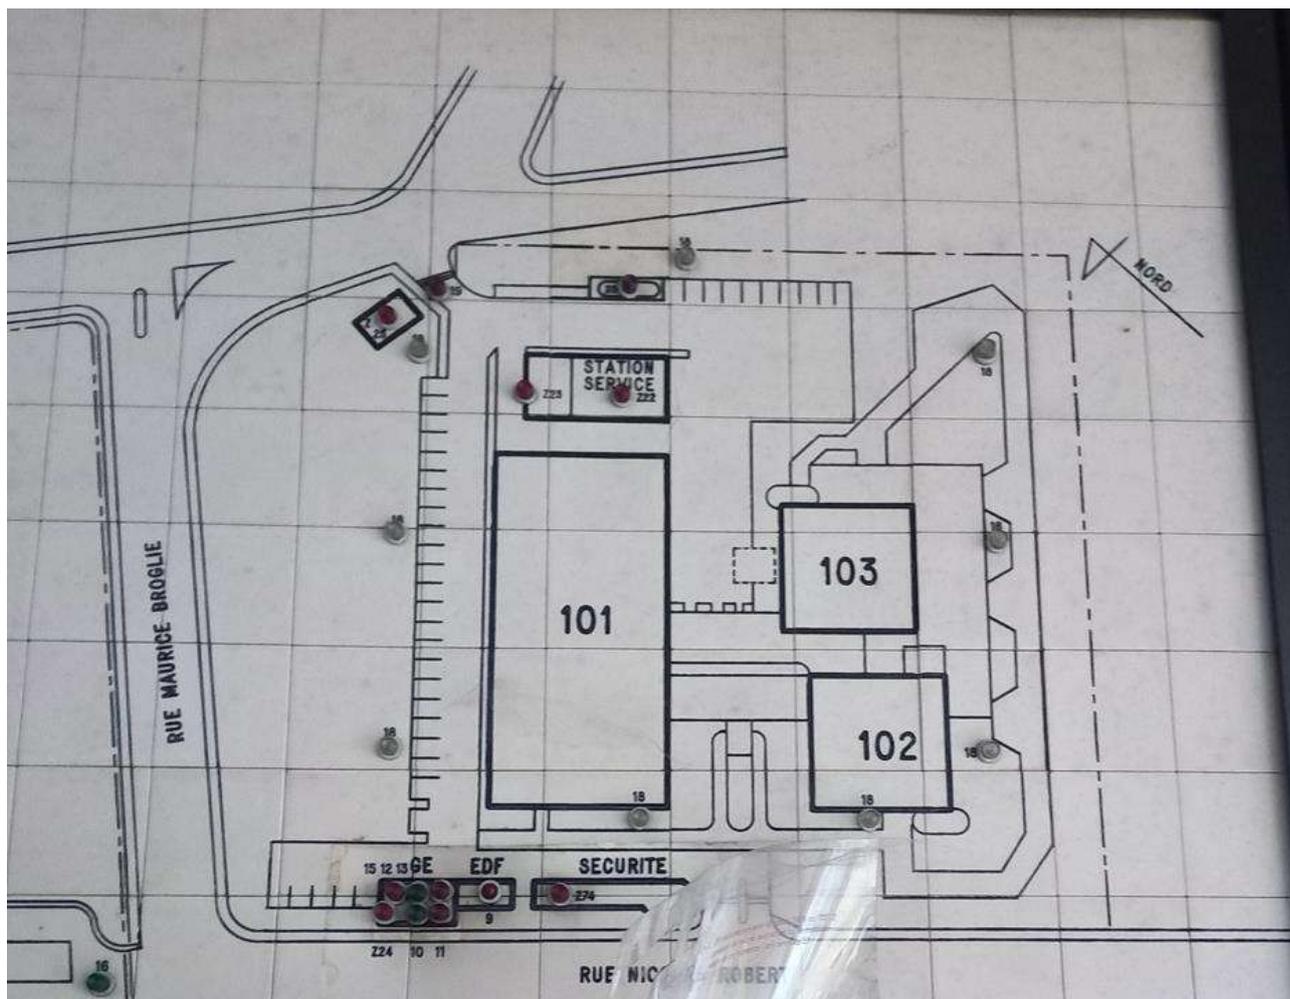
ancien plan de masse non daté du site (sans échelle)
